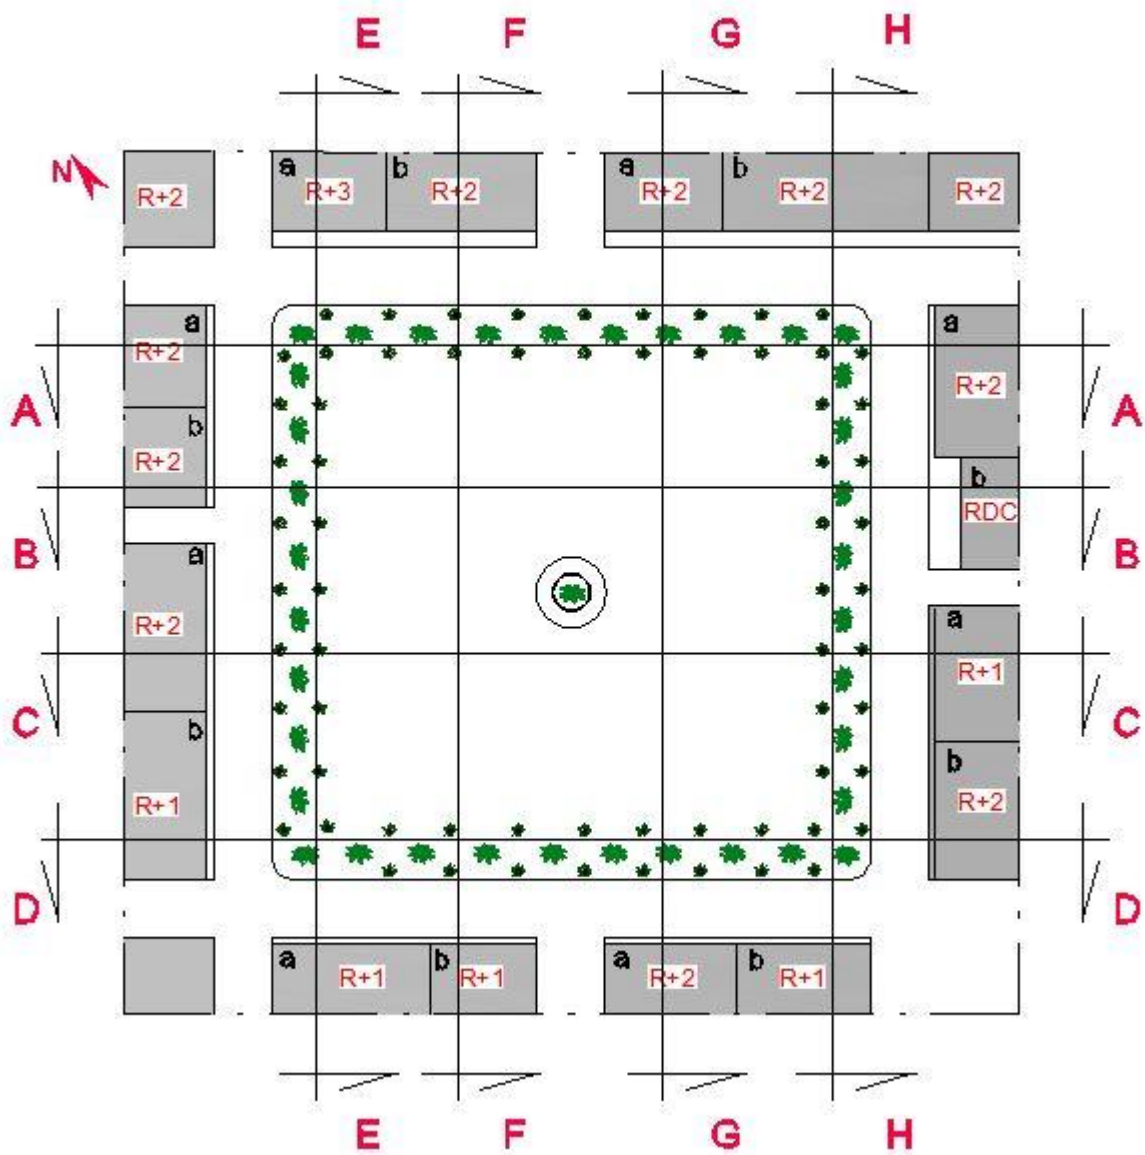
Choix des coupes sur le plan de la place du 1er Novembre, sur Autodesk-Autocad.
